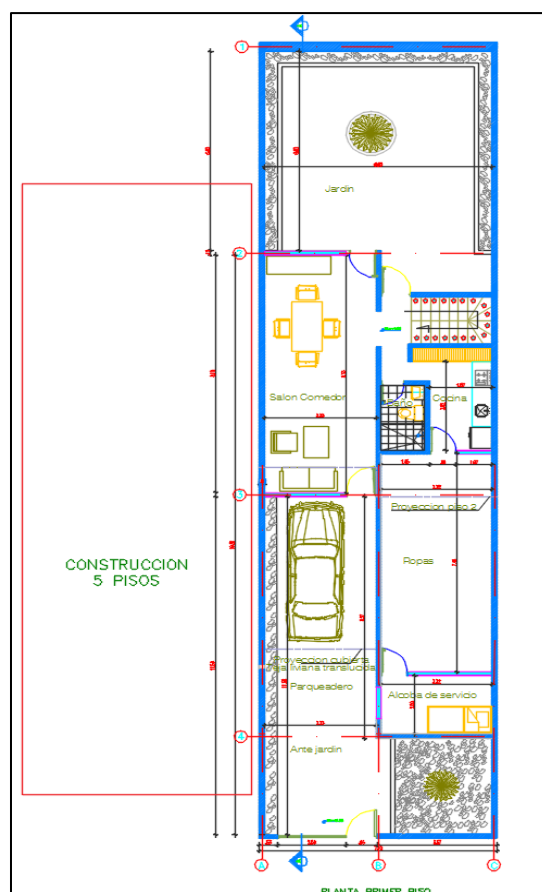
Plano de planta nivel 1. Propietaria de la casa. Fabiola Uribe.
